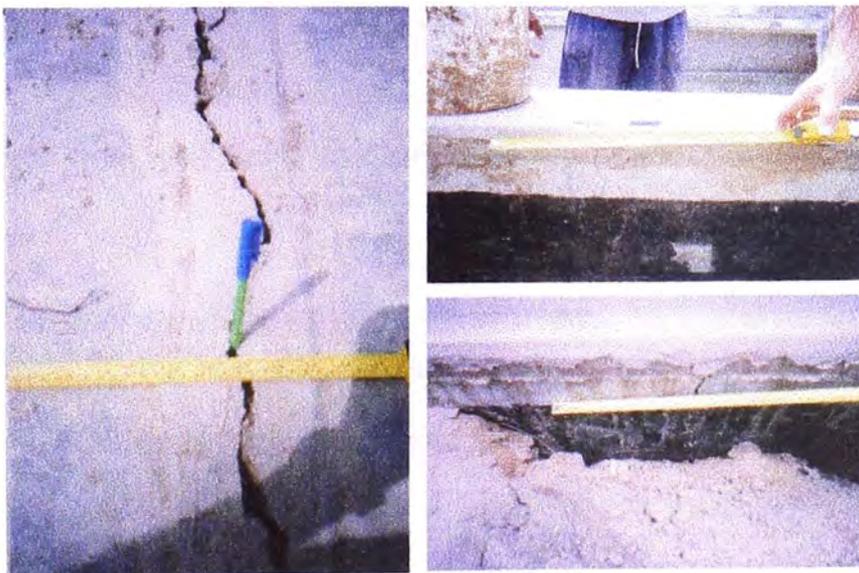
Sistemas de fisuras, a la izquierda la grieta principal y a la derecha otras grietas del lado norte y sur respectivamente.
